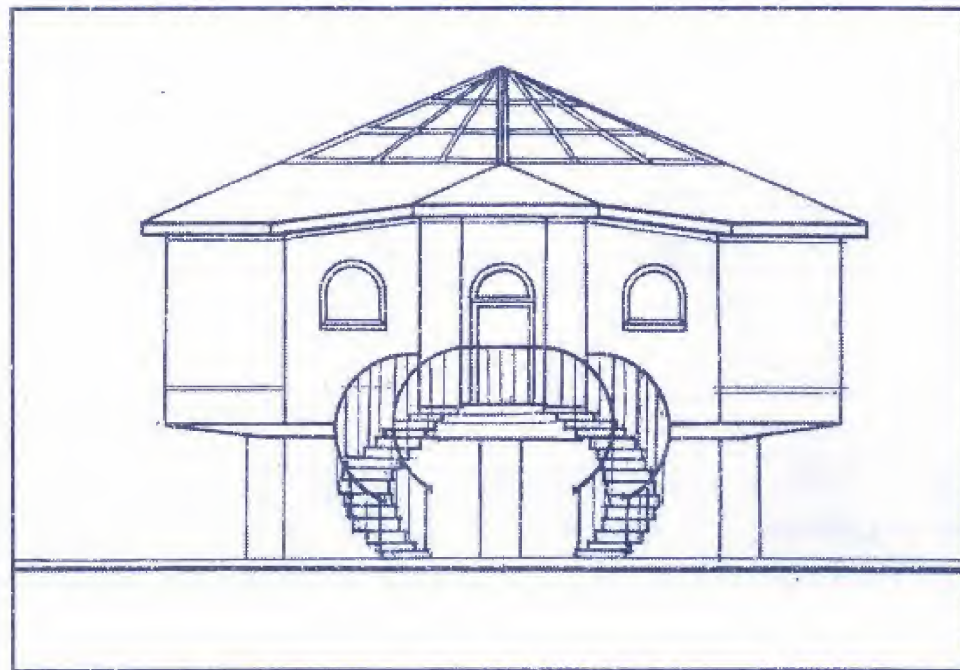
Головний фасад жилої будівлі "на ніжках"
